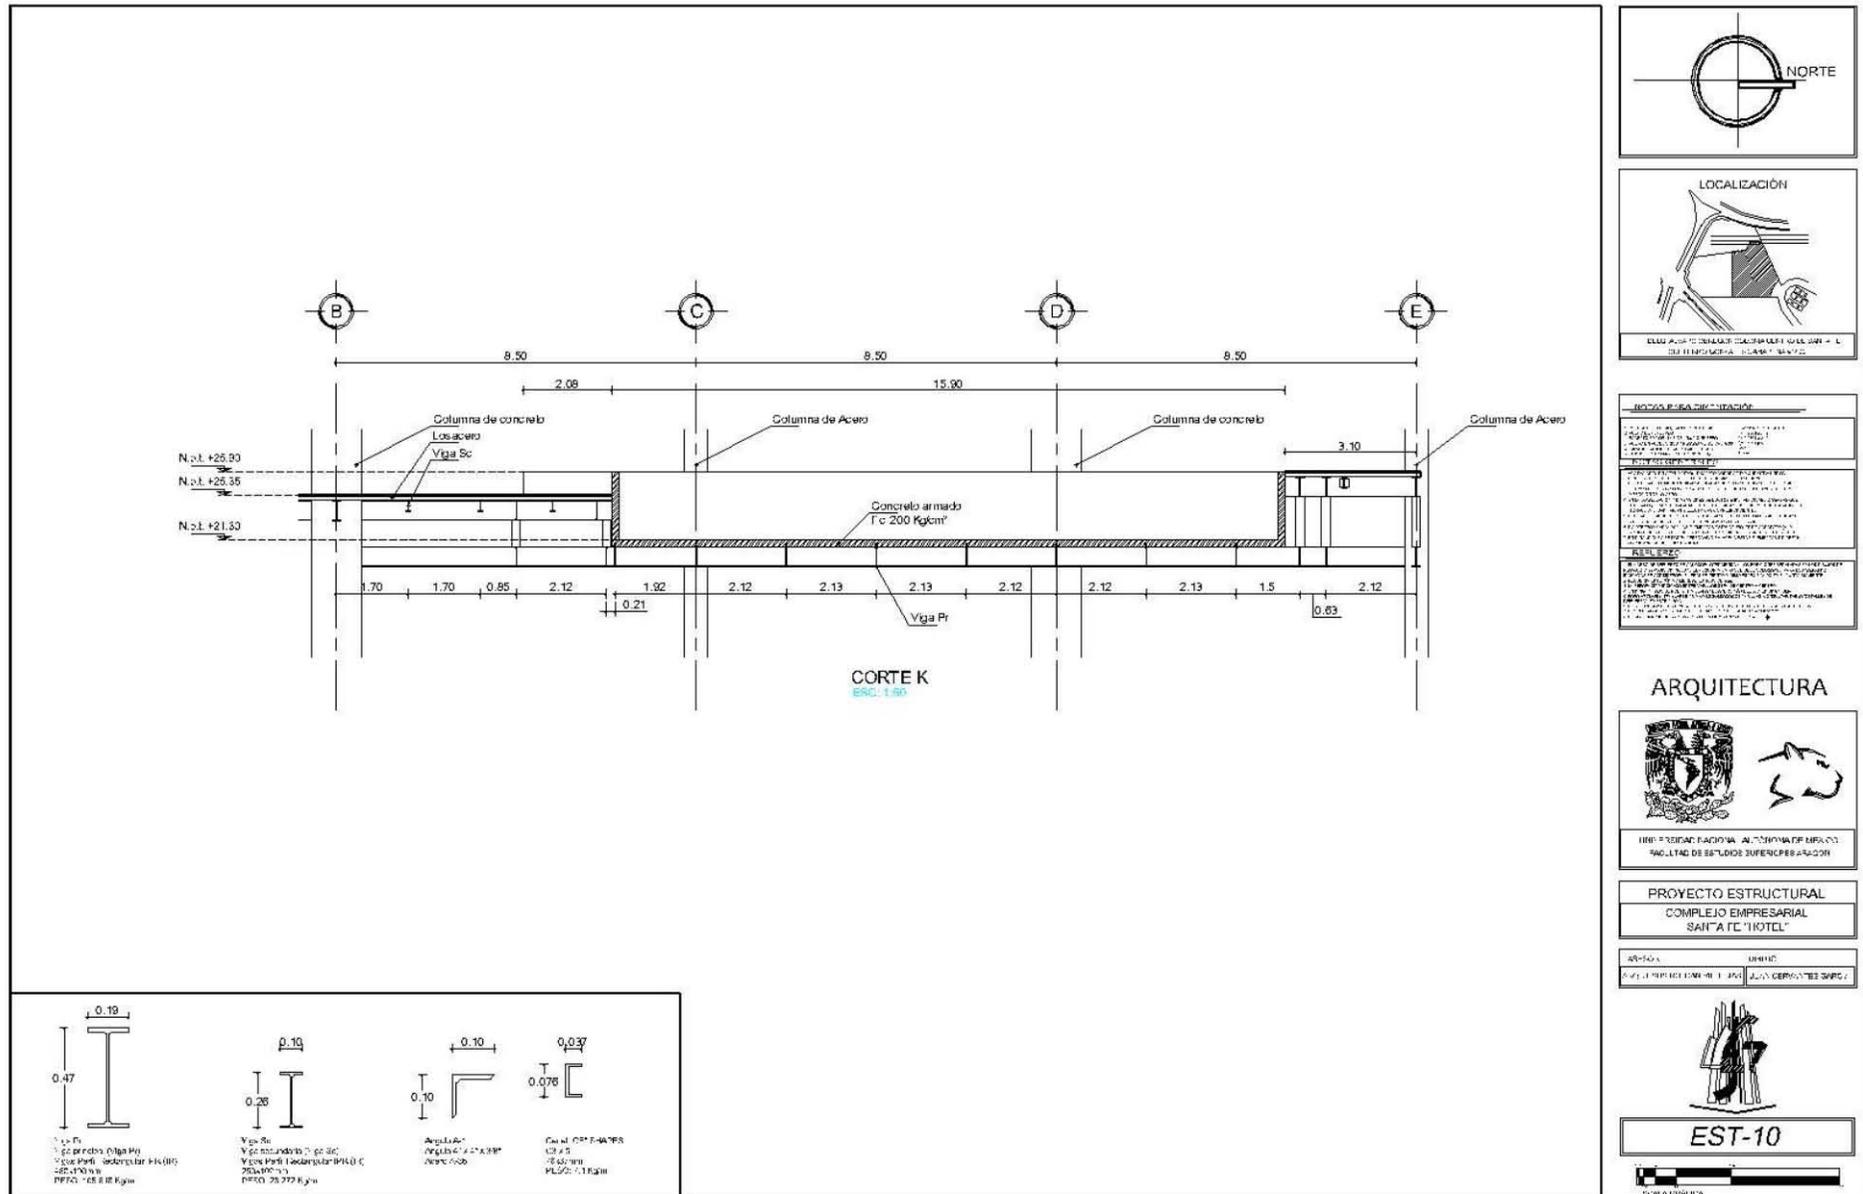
Plano Est-10; Detalle estructural de alberca. Edición propia.
